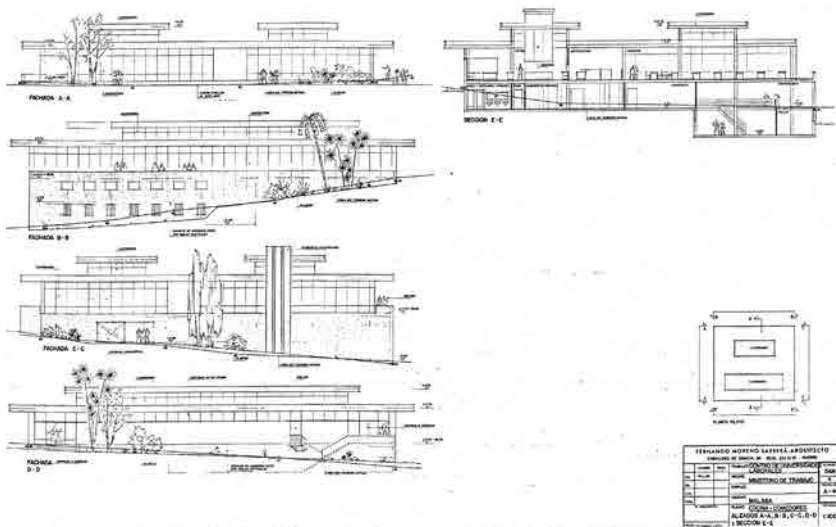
, Fig. 96, Fig. 97, Fig. 98 y Fig. 99 Propuesta previa: edificio de comedores-cocinas y servicios. Alzado de la fachada Noroeste (arriba izquierda), sección (arriba derecha), alzado de la fachada Noreste (centro superior), alzado de la fachada Sureste (centro inferior) y alzado de la fachada Suroeste (abajo).
